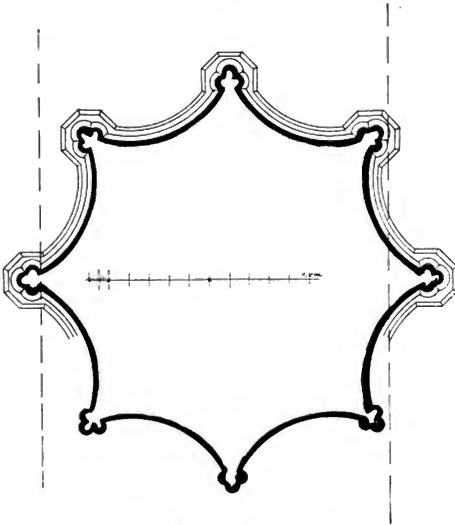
Nikolaikirche: Pfeilergrundriß.
